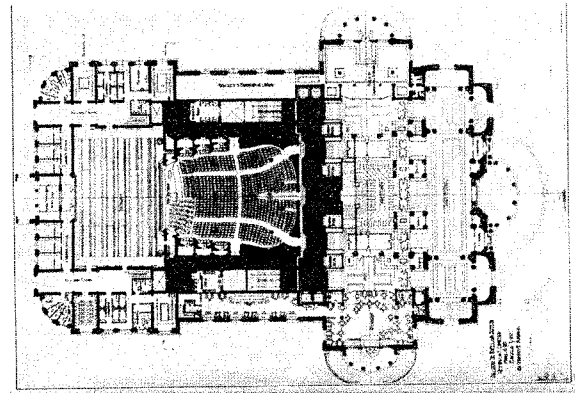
Planta baja original del Palacio de las Bellas Artes
